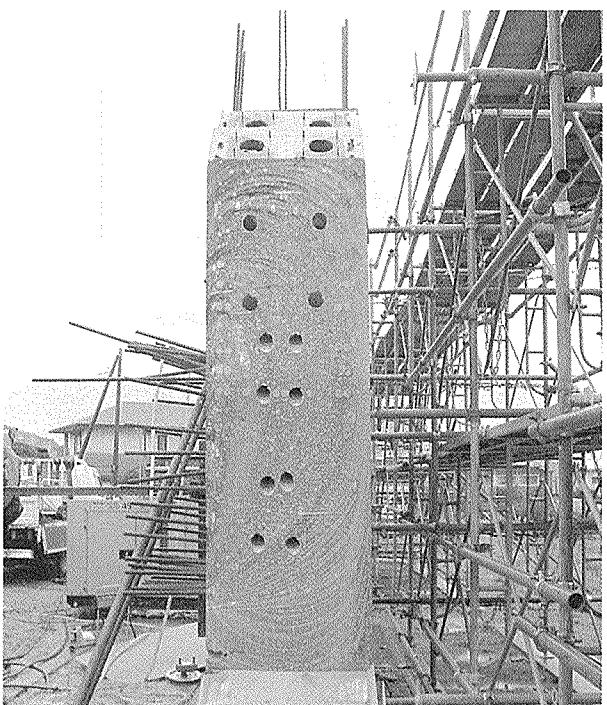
コンクリートの充填状況の確認（ワイヤーソーで断面を切断）
